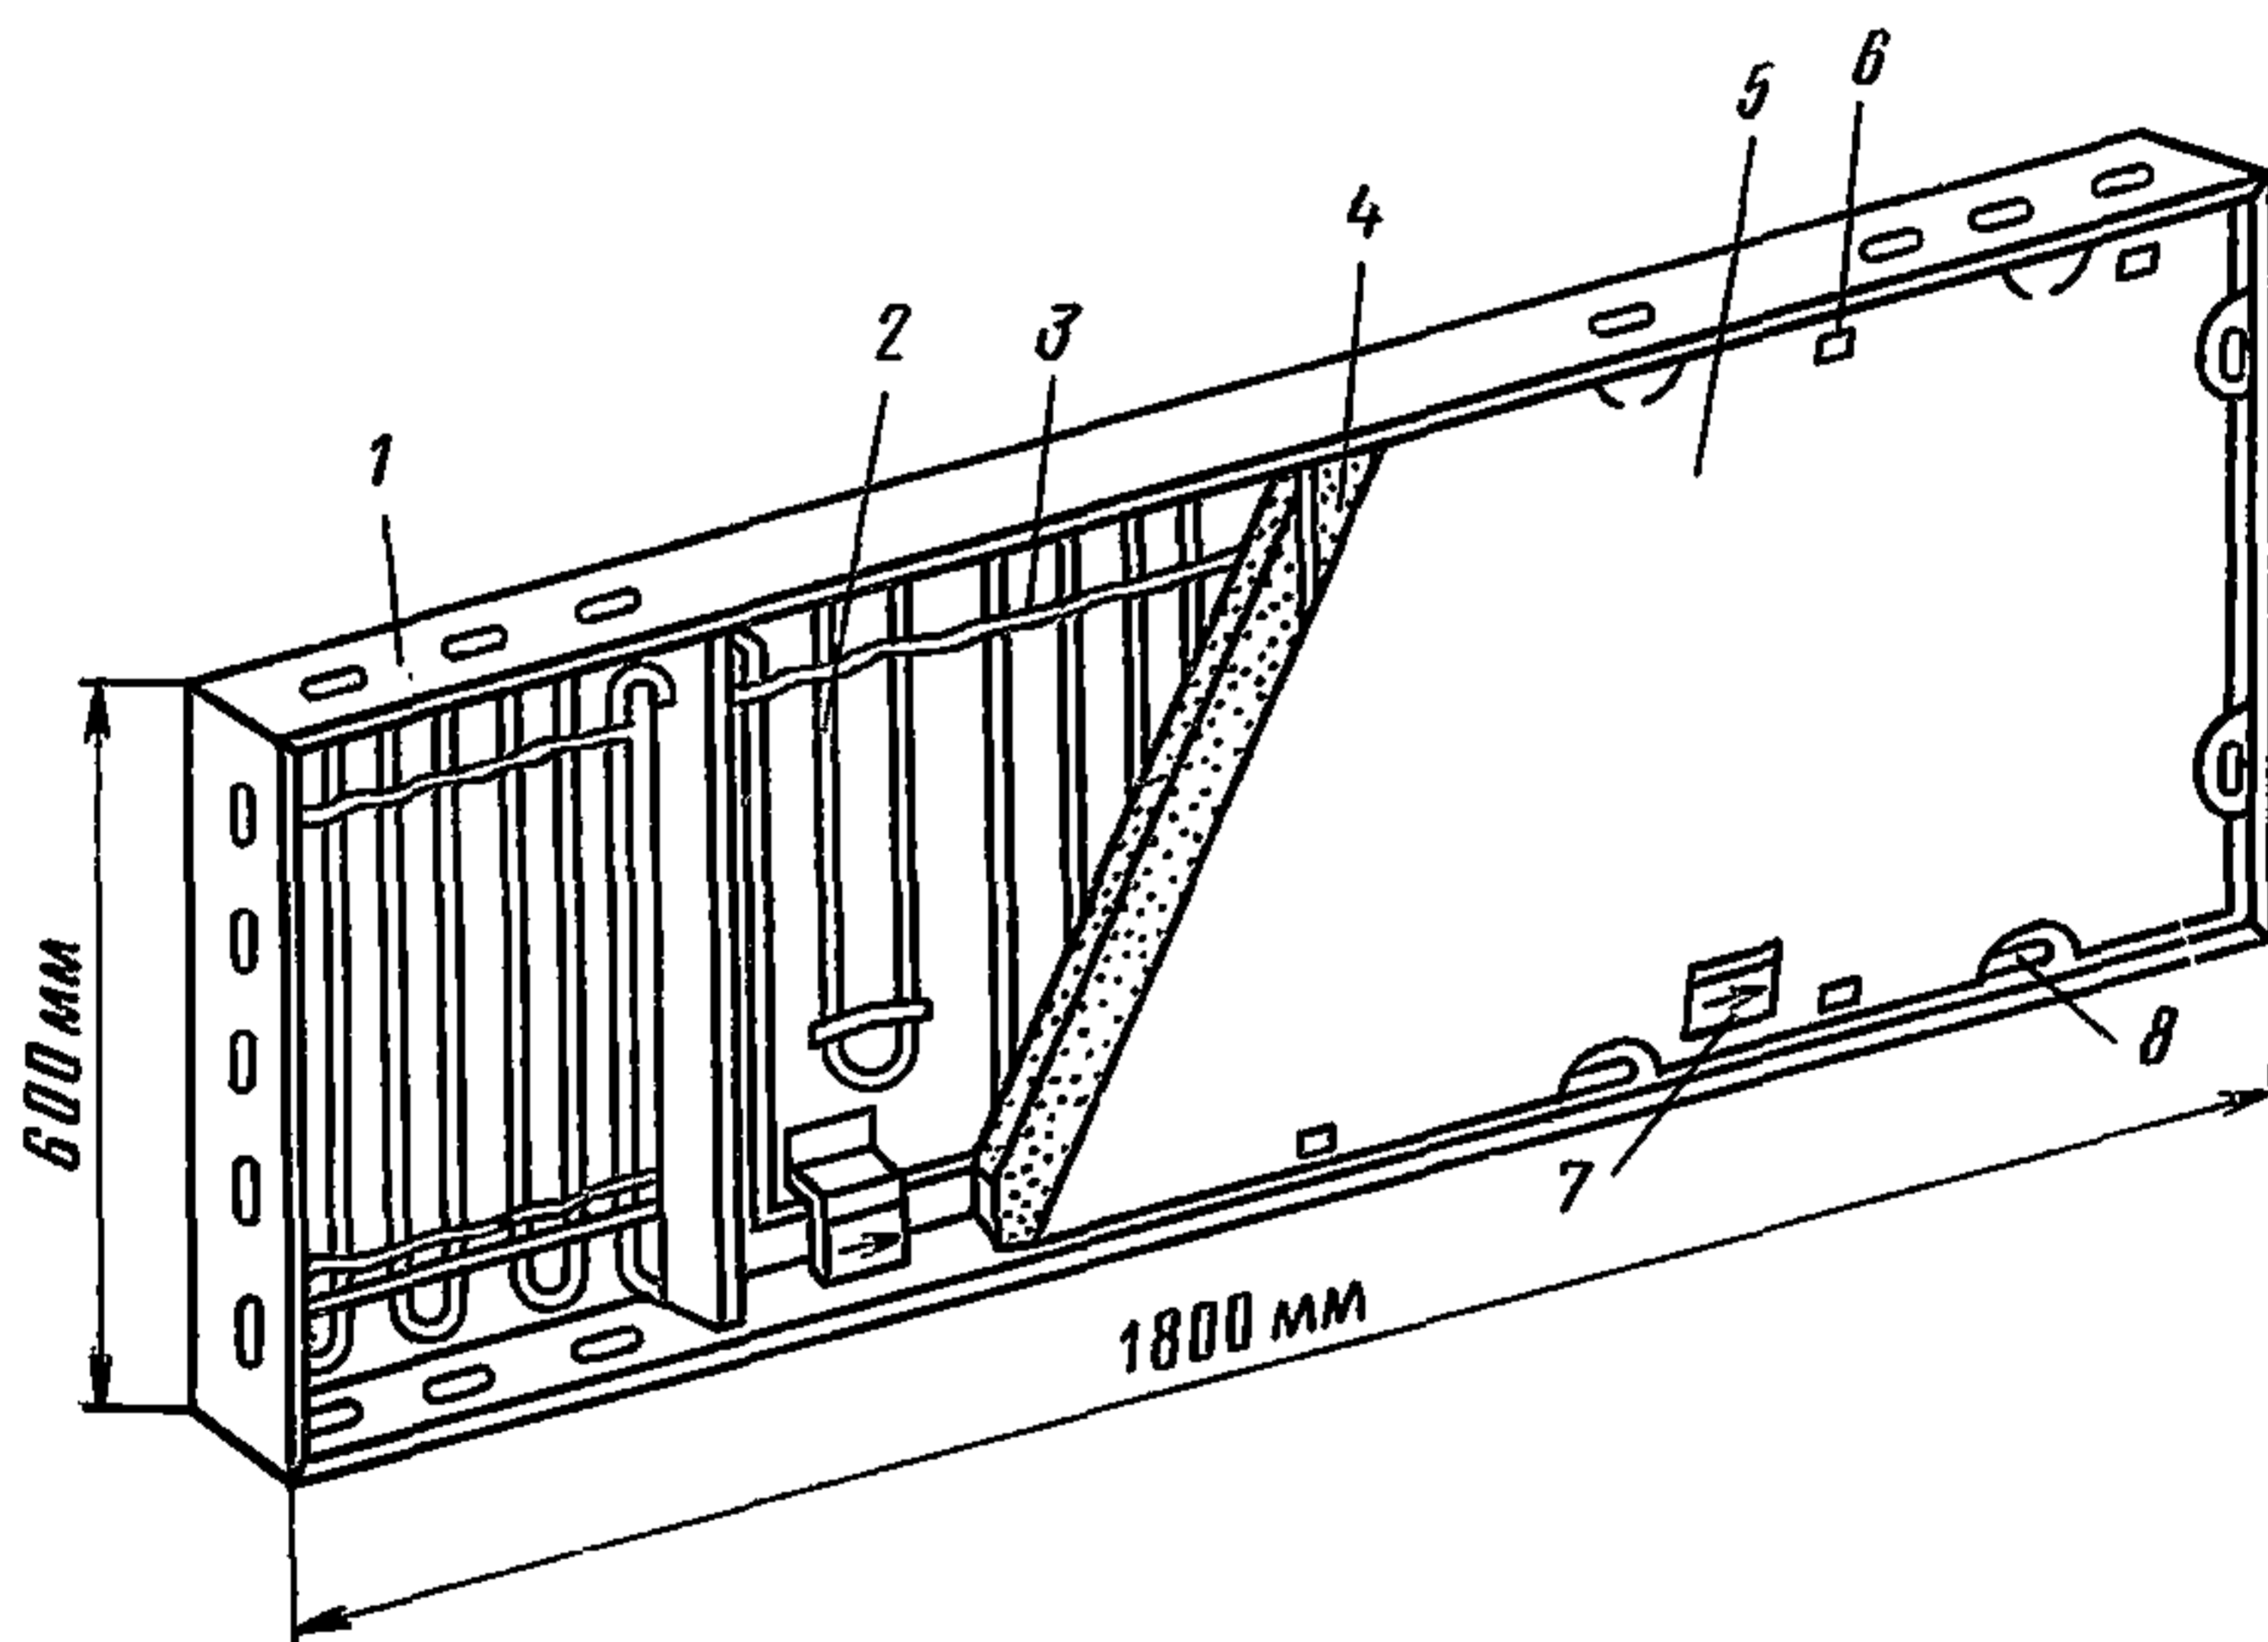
Щит разборно-переставной опалубки с использованием кабеля КНМС
